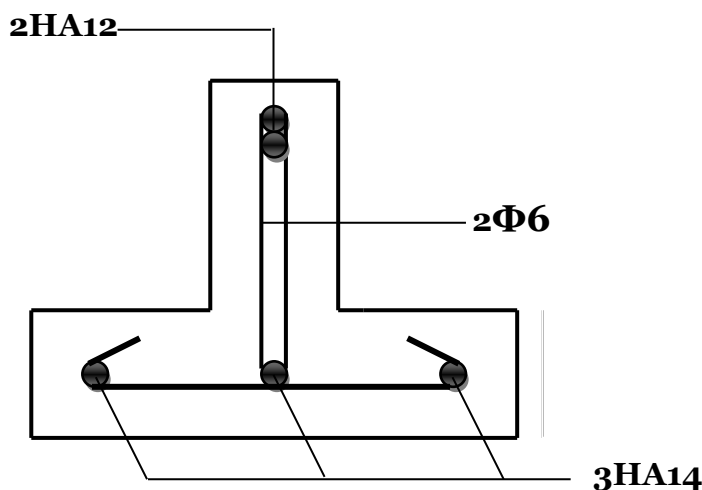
disposition des armatures dans la poutrelle en appuis et en travée.
